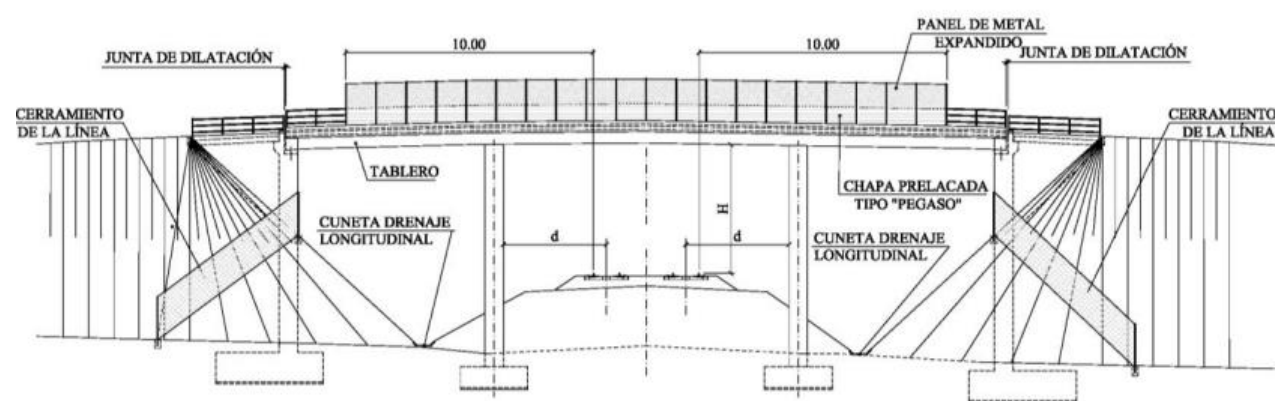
Sección tipo paso superior sobre plataforma ferroviaria
